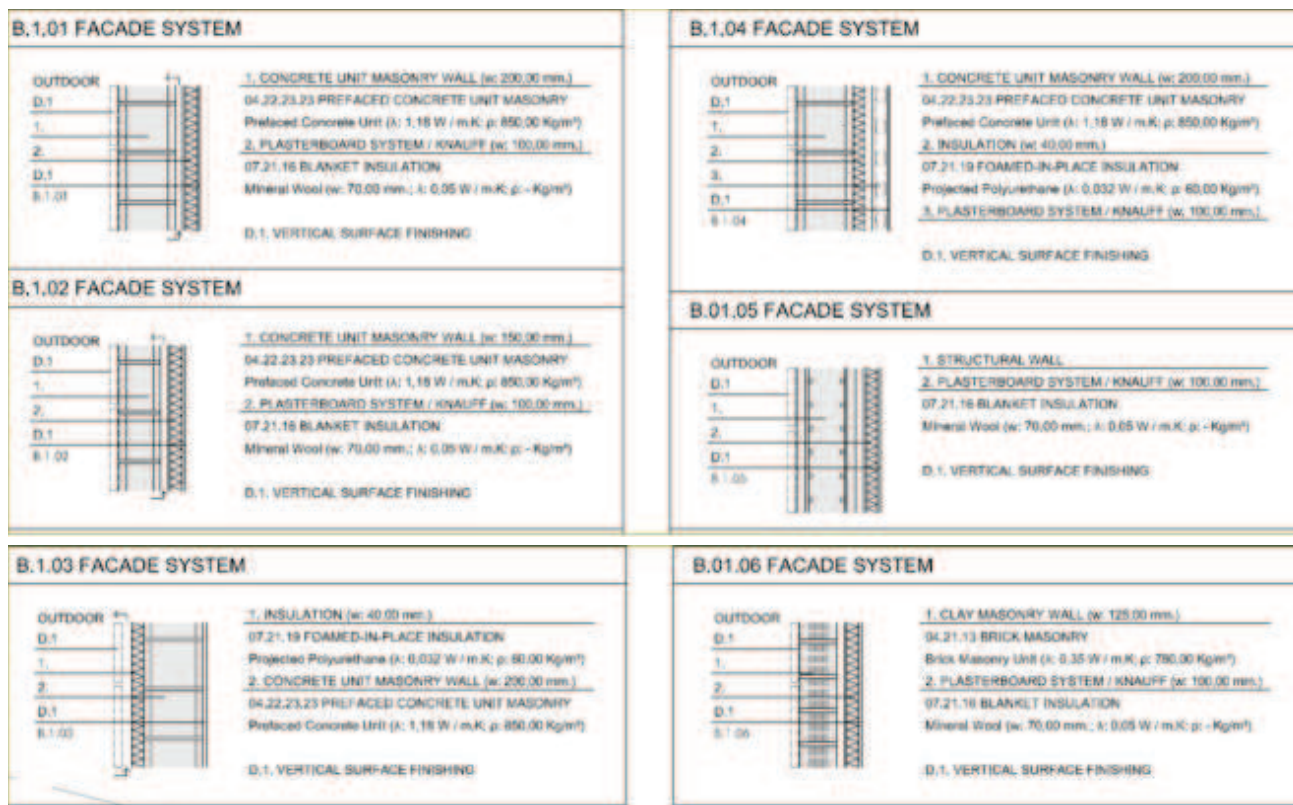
Compositions des différents murs de la fondation Quattan à Ramallah. Source: Bonaire Arch.
